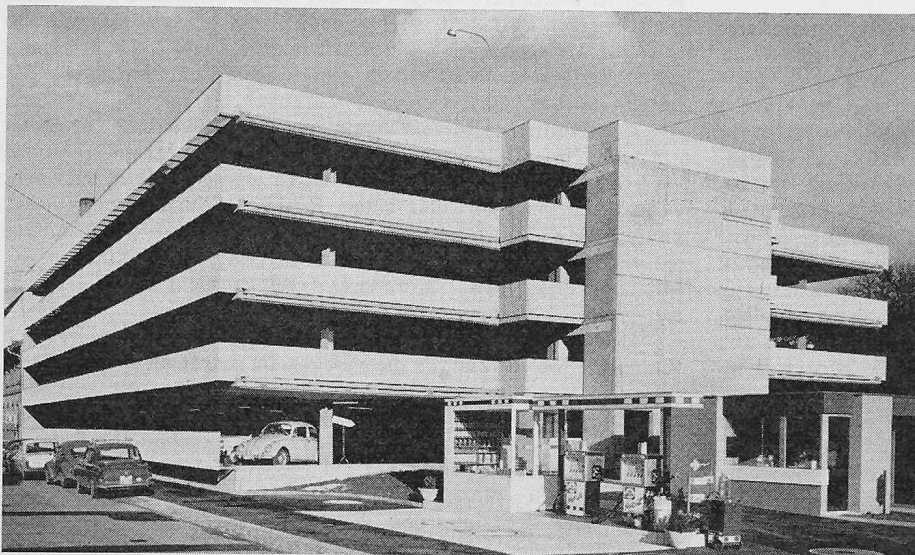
Parkhaus Sihlquai, Zürich: Stahlstützen und vorfabrizierte Betonelemente
